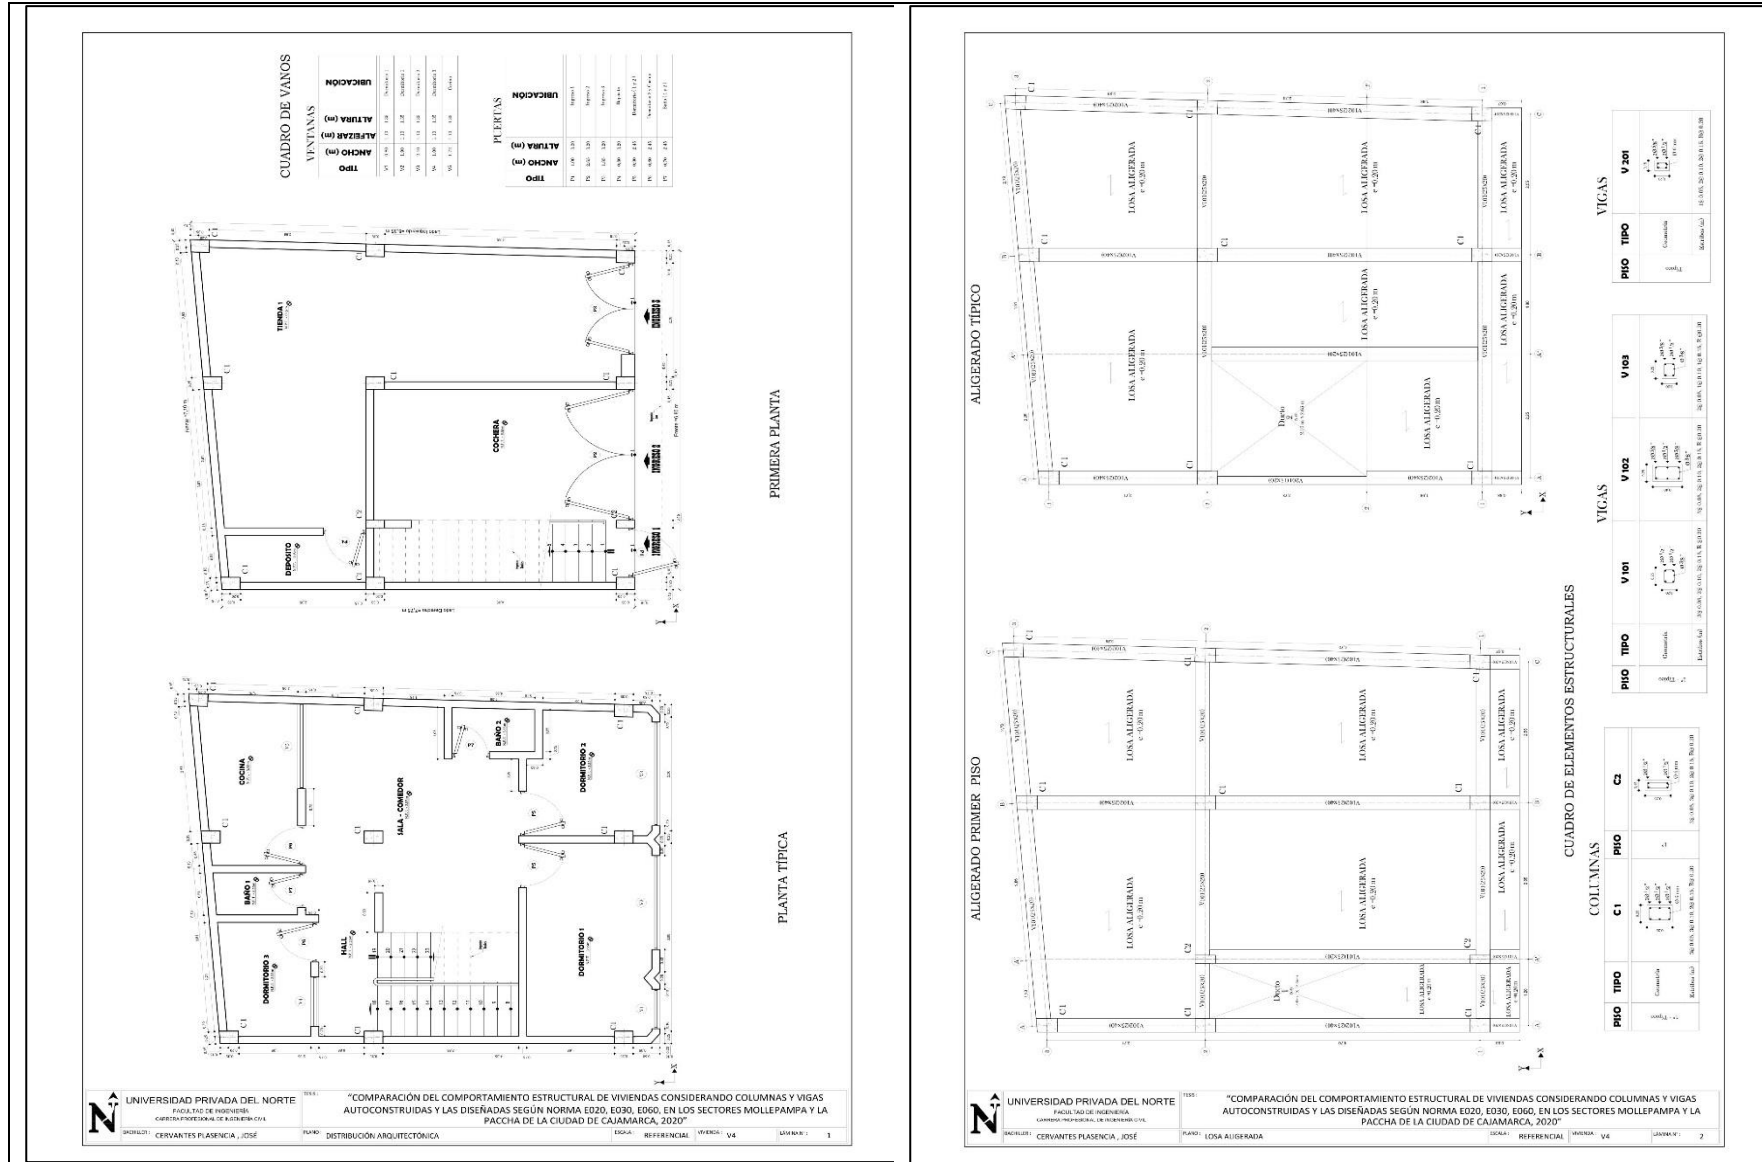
Planos de arquitectura y losa aligerada vivienda 4
